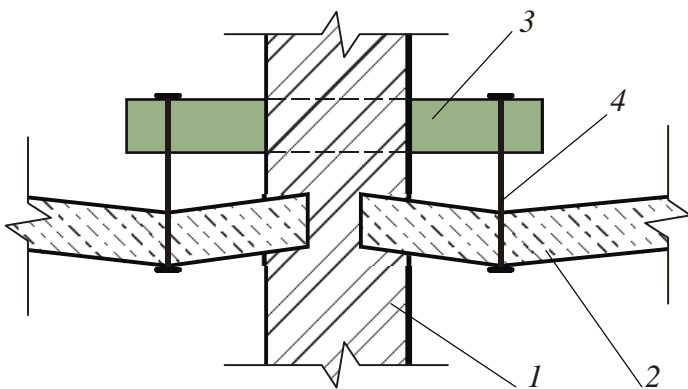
Устранение прогиба перекрытий у несущих стен:
